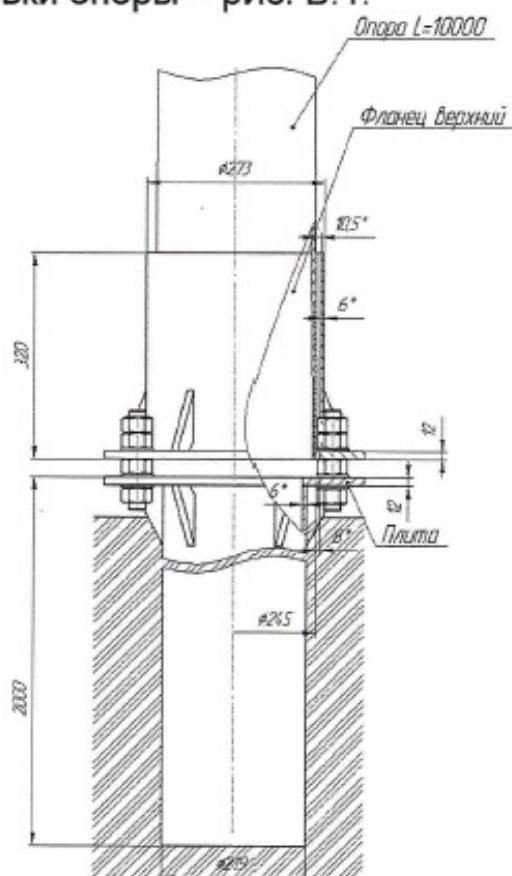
Способ установки опоры в фундамент с квадратным фланцем
